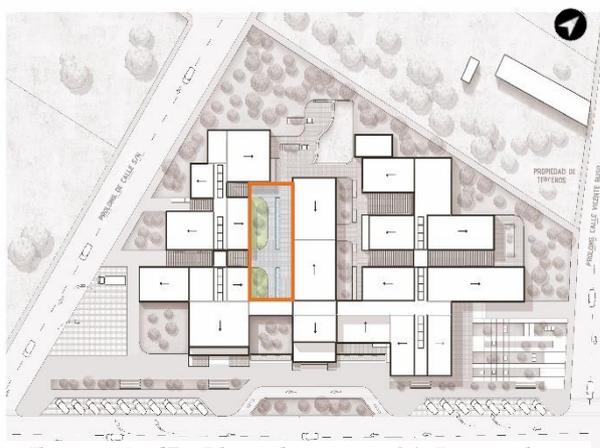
Plano de espacio 04- Recorrido multisensorial 02.
